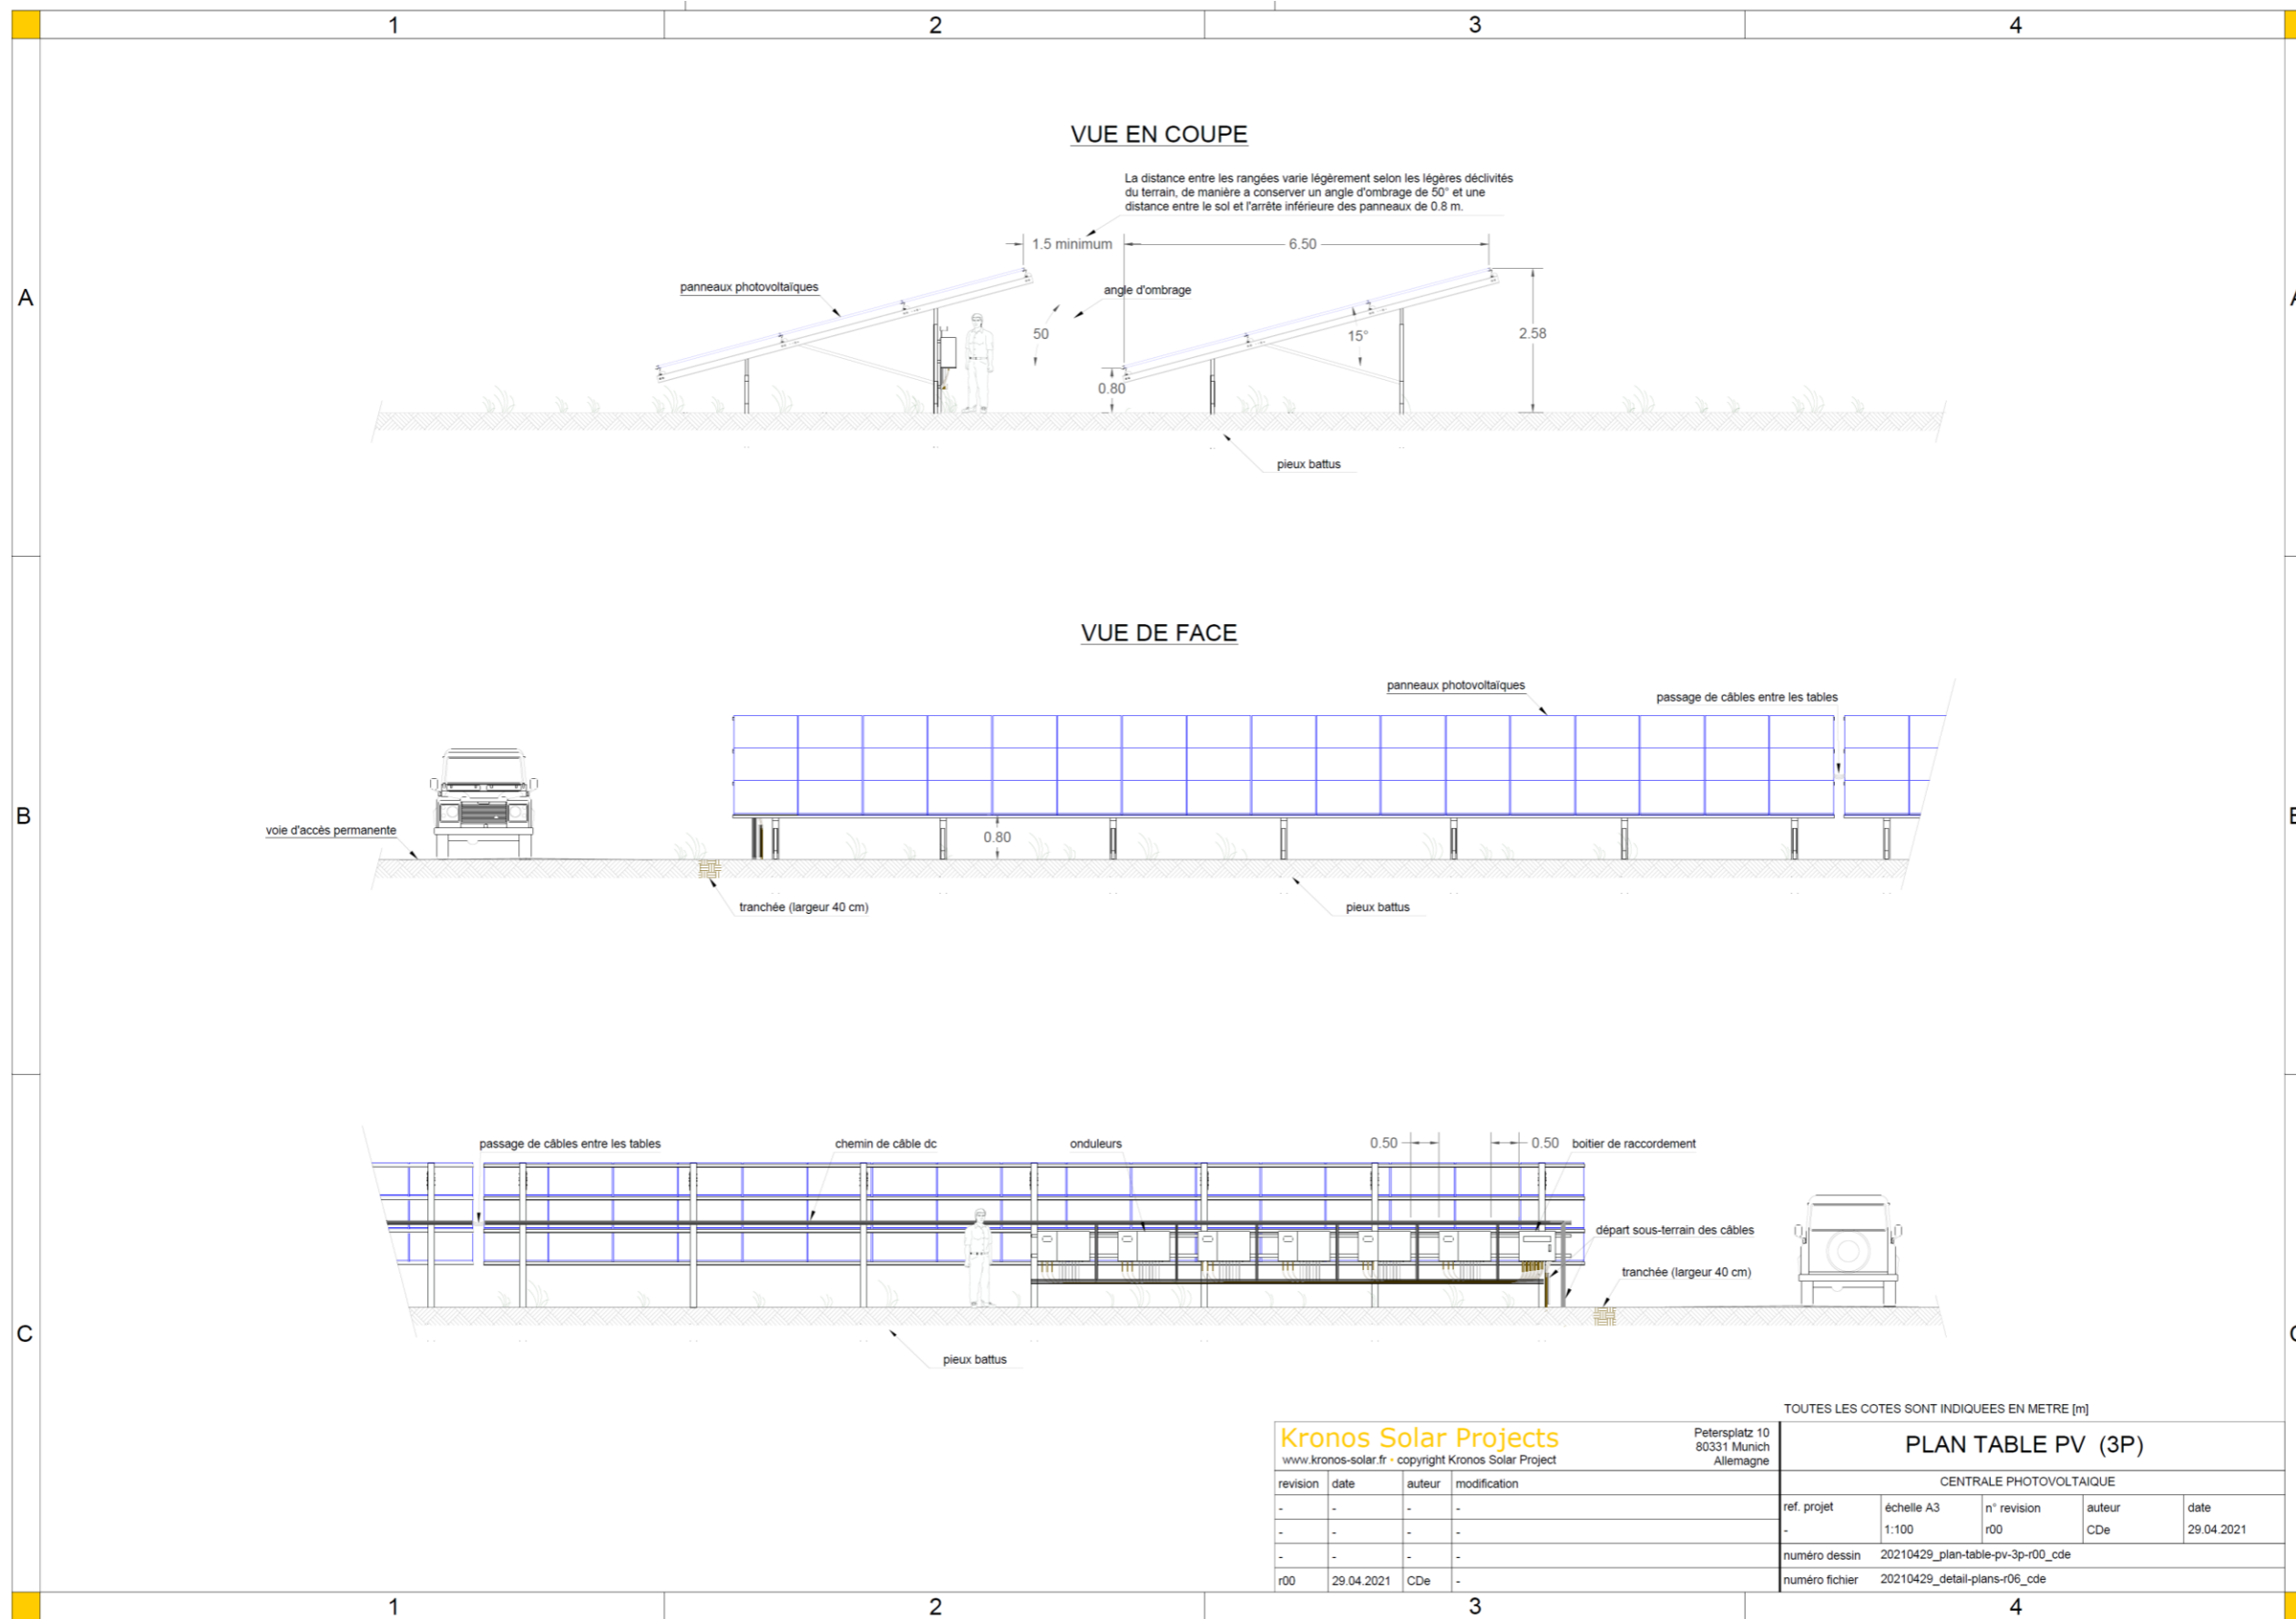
Plan des tables de panneaux (Source : Porteur de projet)
